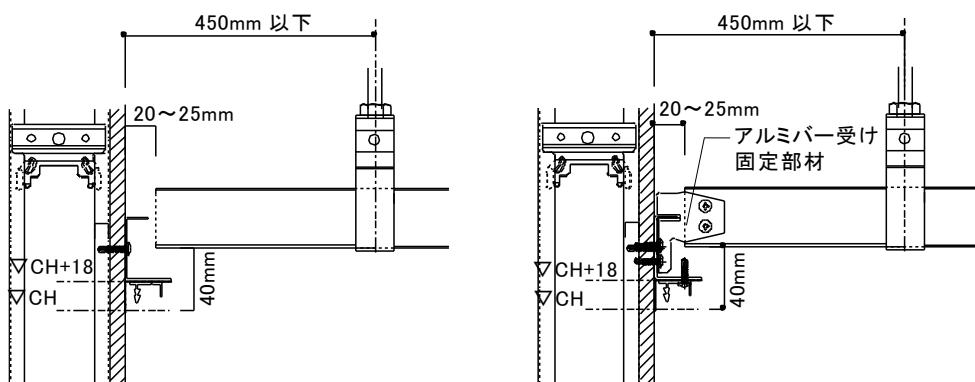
アルミバー受け固定部材の施工手順(壁面が軽量鉄骨の場合)
